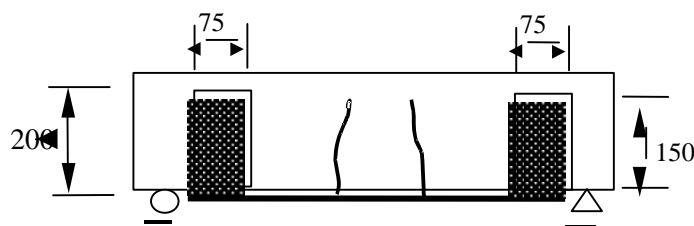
Mode de renforcement b de la poutre n°16 (HA 8)
